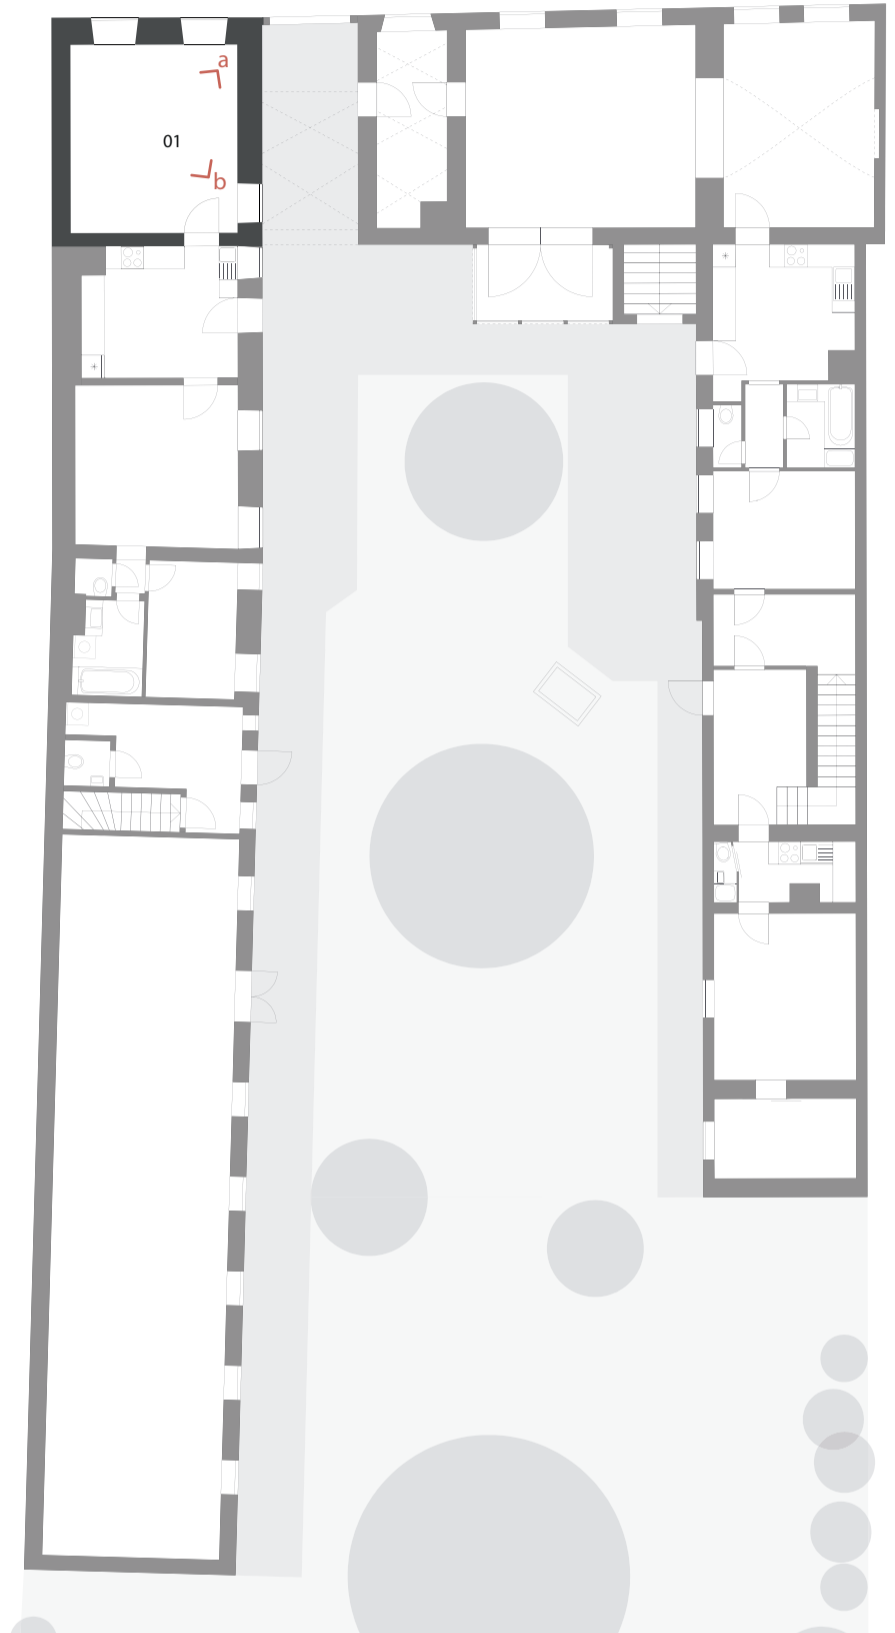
Grundriss Erdgeschoß | M 1:200 | Raum 01
